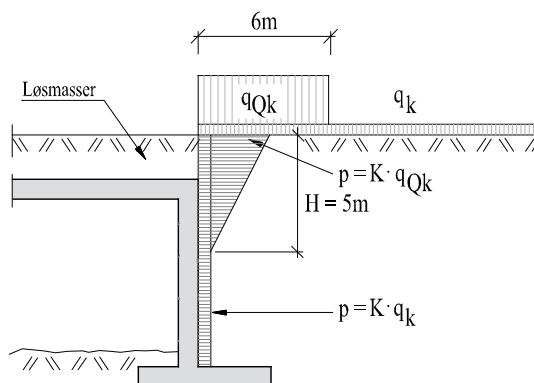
Trafikklast på vegfylling og tilhørende jordtrykk, snitt A - A
